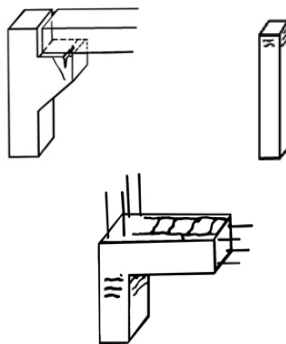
Fisuración en mapa y afección de elementos estructurales con distinta rigidez
